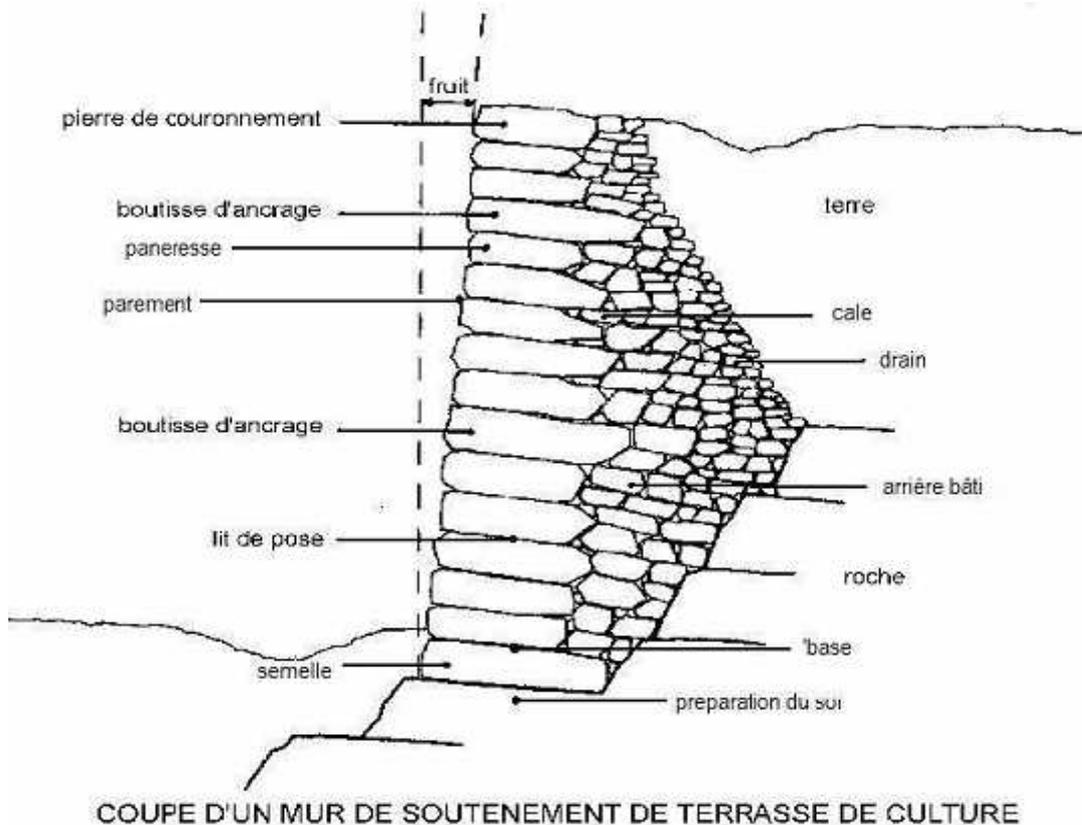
Coupe d'un mur de soutènement de terrasse de culture
